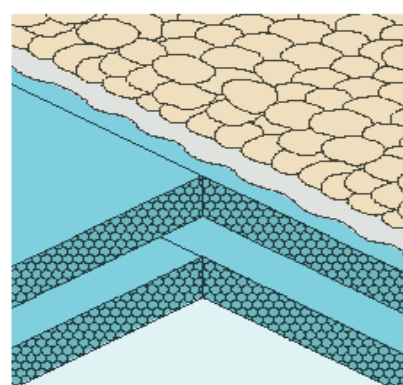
Empleo de geotextil de separación entre la protección pesada y las planchas de XPS, en cubierta plana invertida³.
